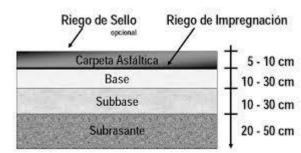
Sección transversal de la estructura de pavimentos flexibles³.
